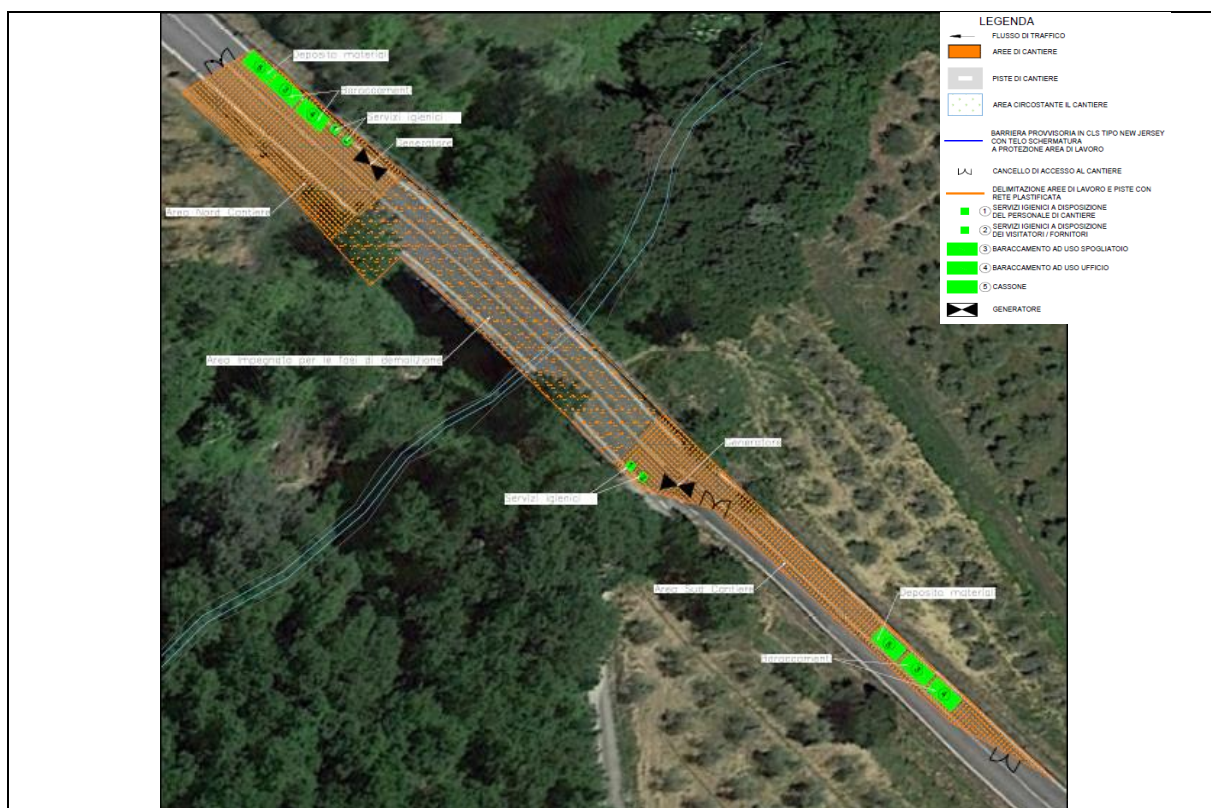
Cantiere Fase 2a: Demolizione ponte esistente, realizzazione elevazioni nuove spalle.
